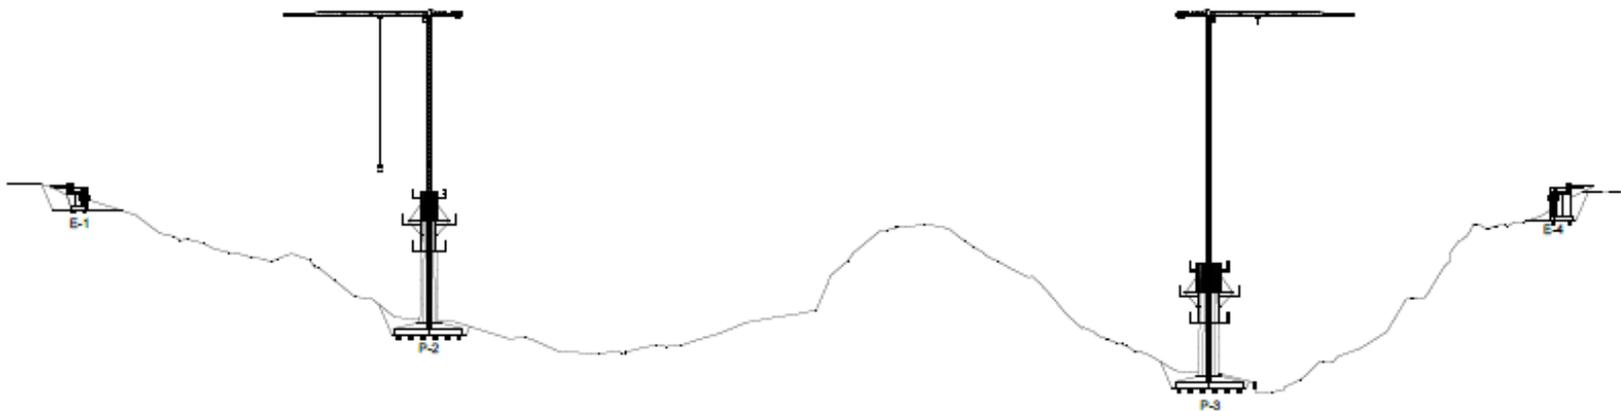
Fase 3: Construcción de torres de concreto hasta zona de tirantes.
